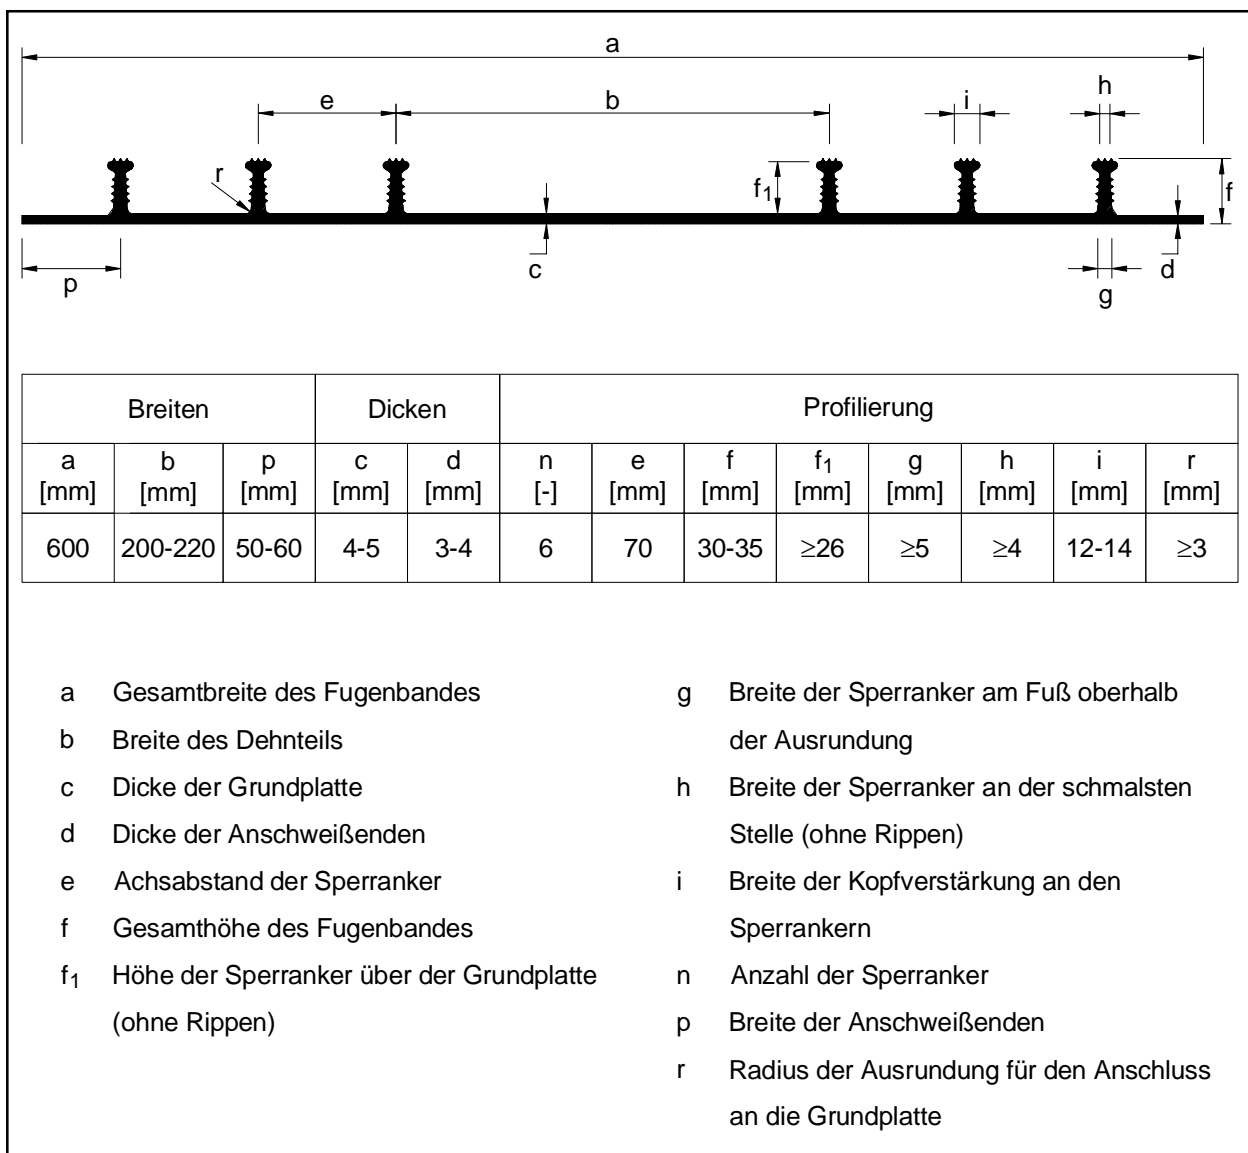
Grundabmessungen Schottfugenband, Tunnel in geschlossener Bauweise
